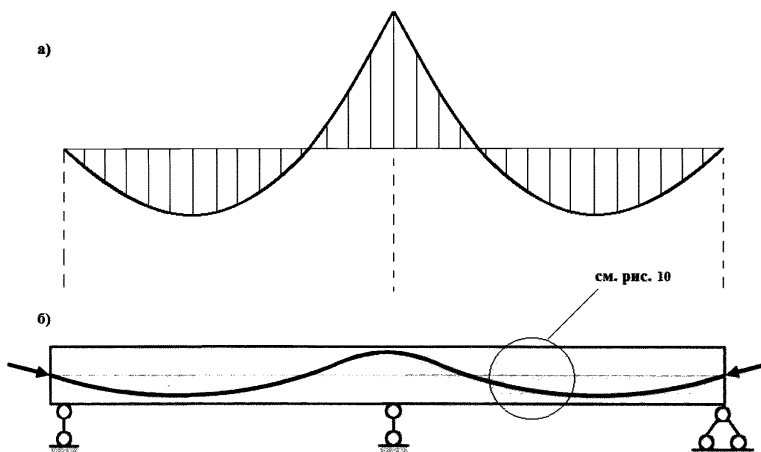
Эпюры изгибающих моментов (а) и схема раскладки напрягаемой арматуры (б) по высоте сечения неразрезной конструкции
